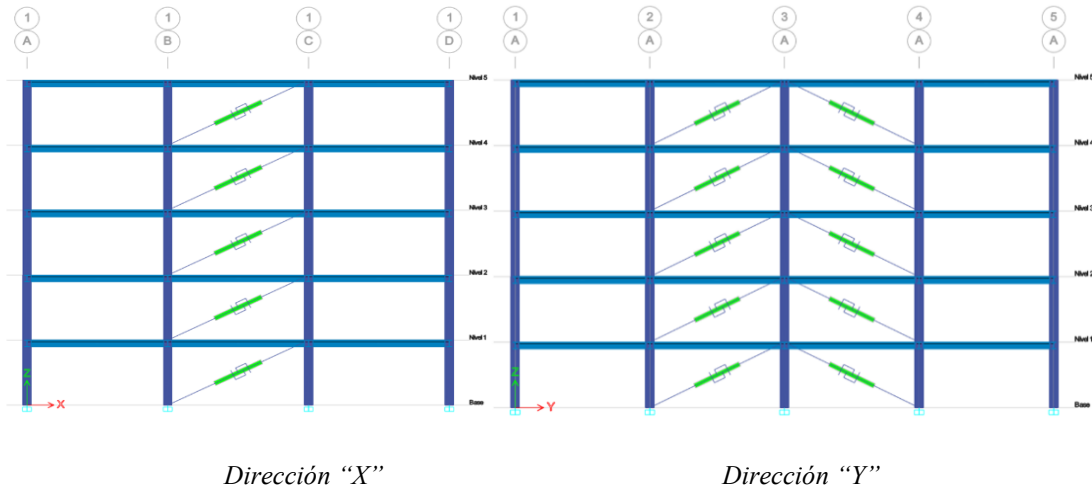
Vista en elevación de la distribución de contravientos restringidos al pandeo en dirección "X" y "Y" respectivamente para M5CRP.
